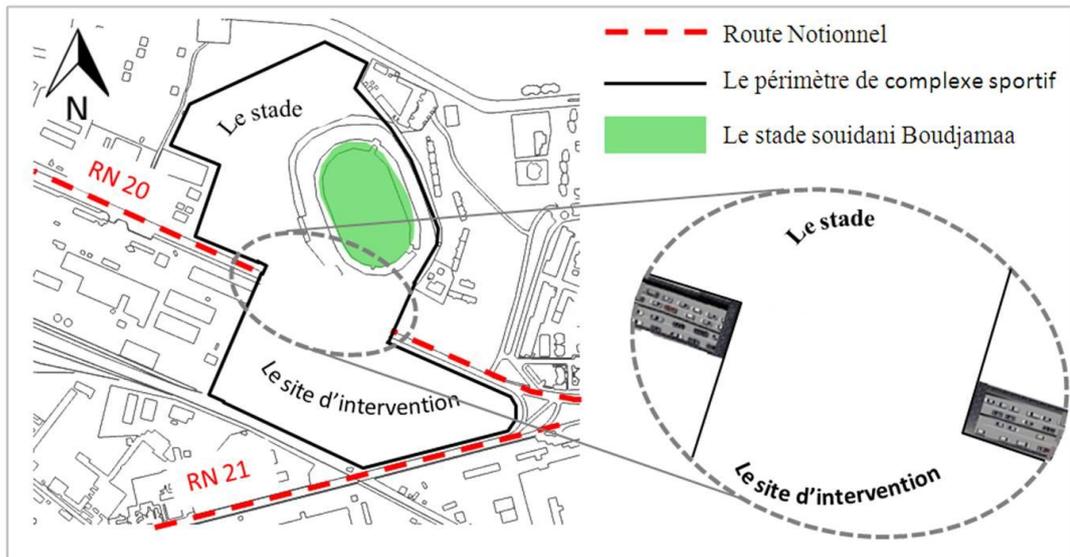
étape 1 : Lier le stade avec le site d'intervention
